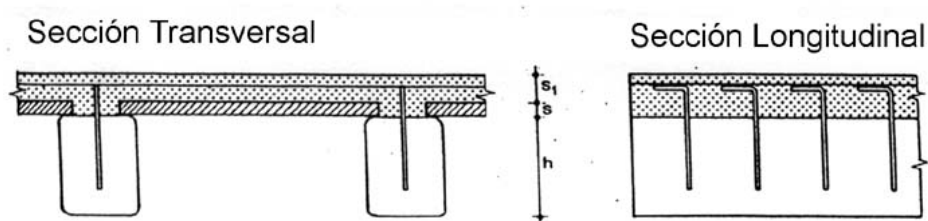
Esquema de conectores trabajando a esfuerzo cortante. El hormigón está en contacto con la viga de madera.
